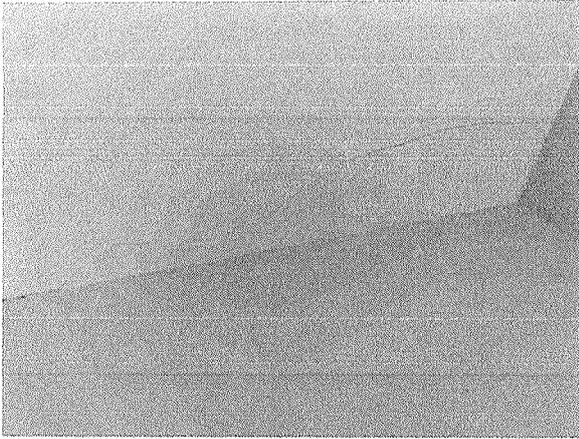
Trinca na laje da sala do berçário 2
